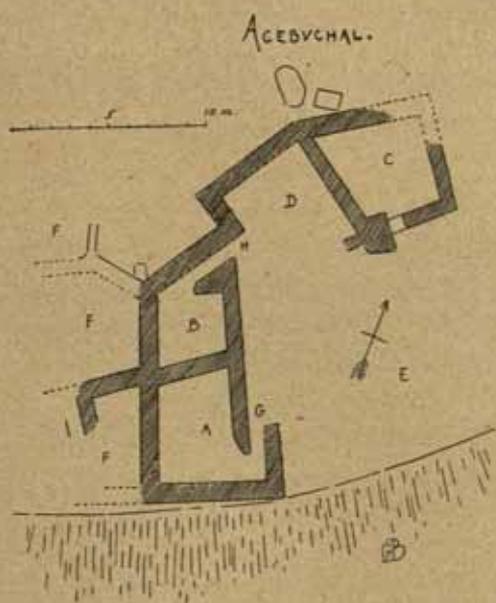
Plan d'une construction pré-romaine à l'Acébuchal.
